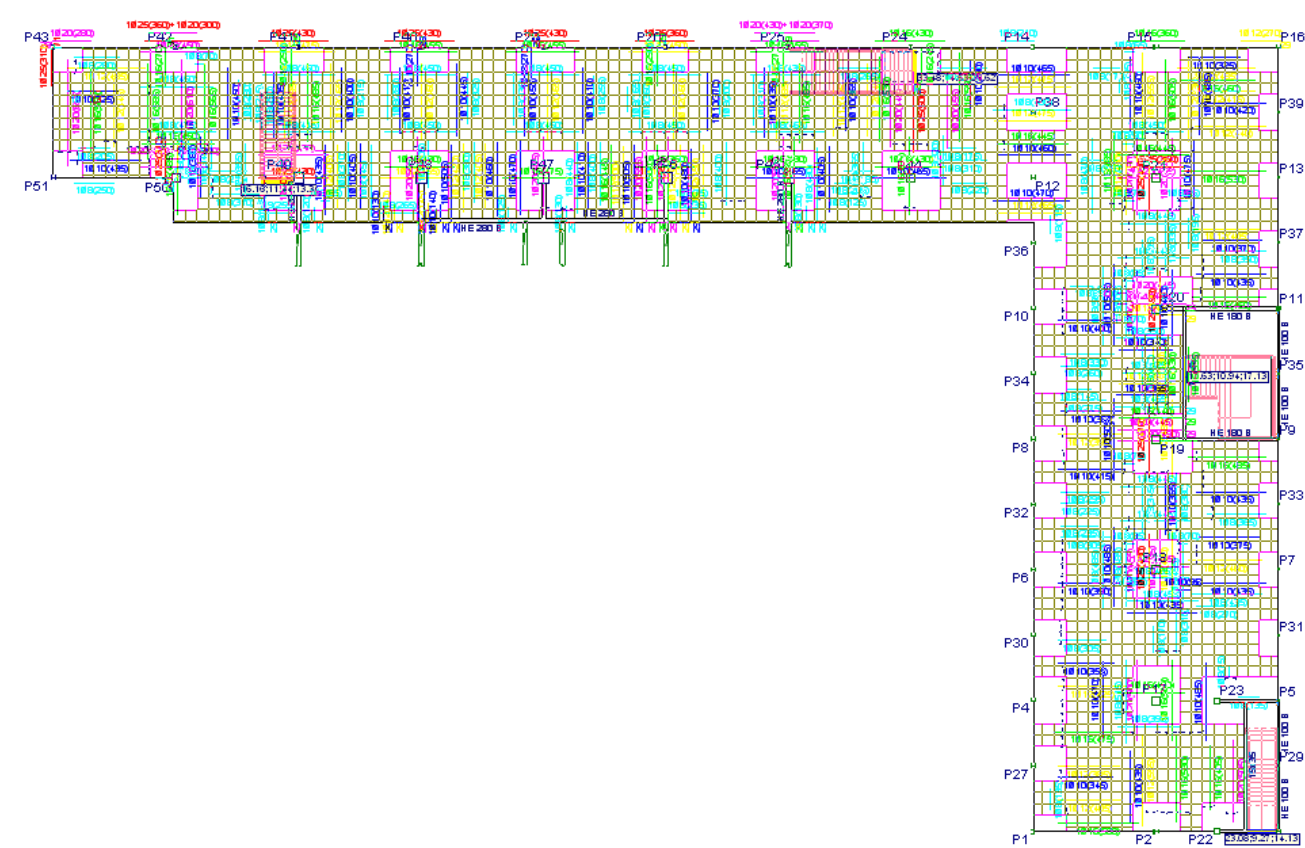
Disposición en planta de la armadura de refuerzo del forjado reticular y los ábacos. Fuente: Propia
